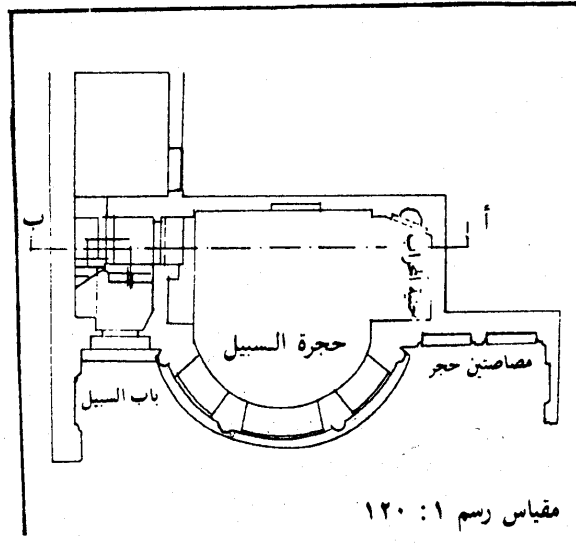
مسقط أفقي وواجهة چشمه Kemankas في استانبول . (عن Barışta) .
